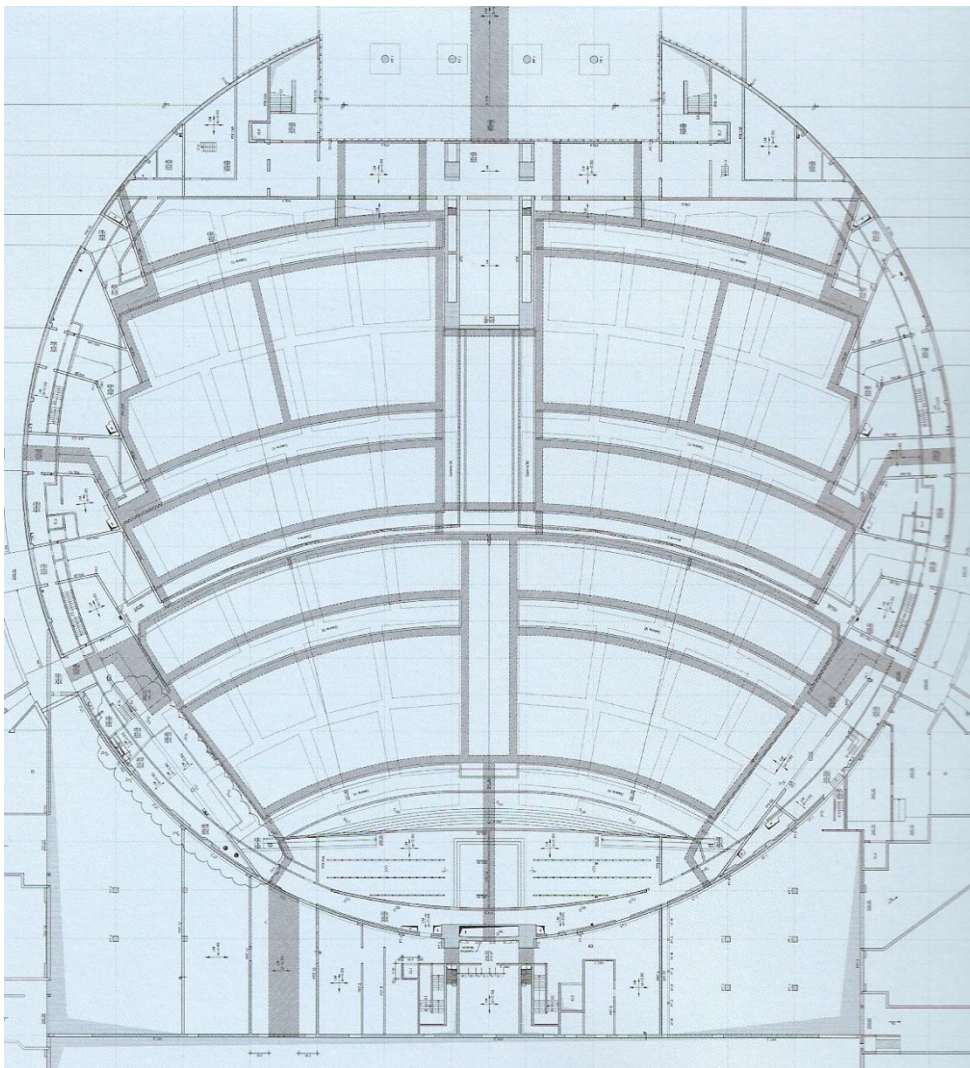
Planta da Igreja Santíssima Trindade [34]
